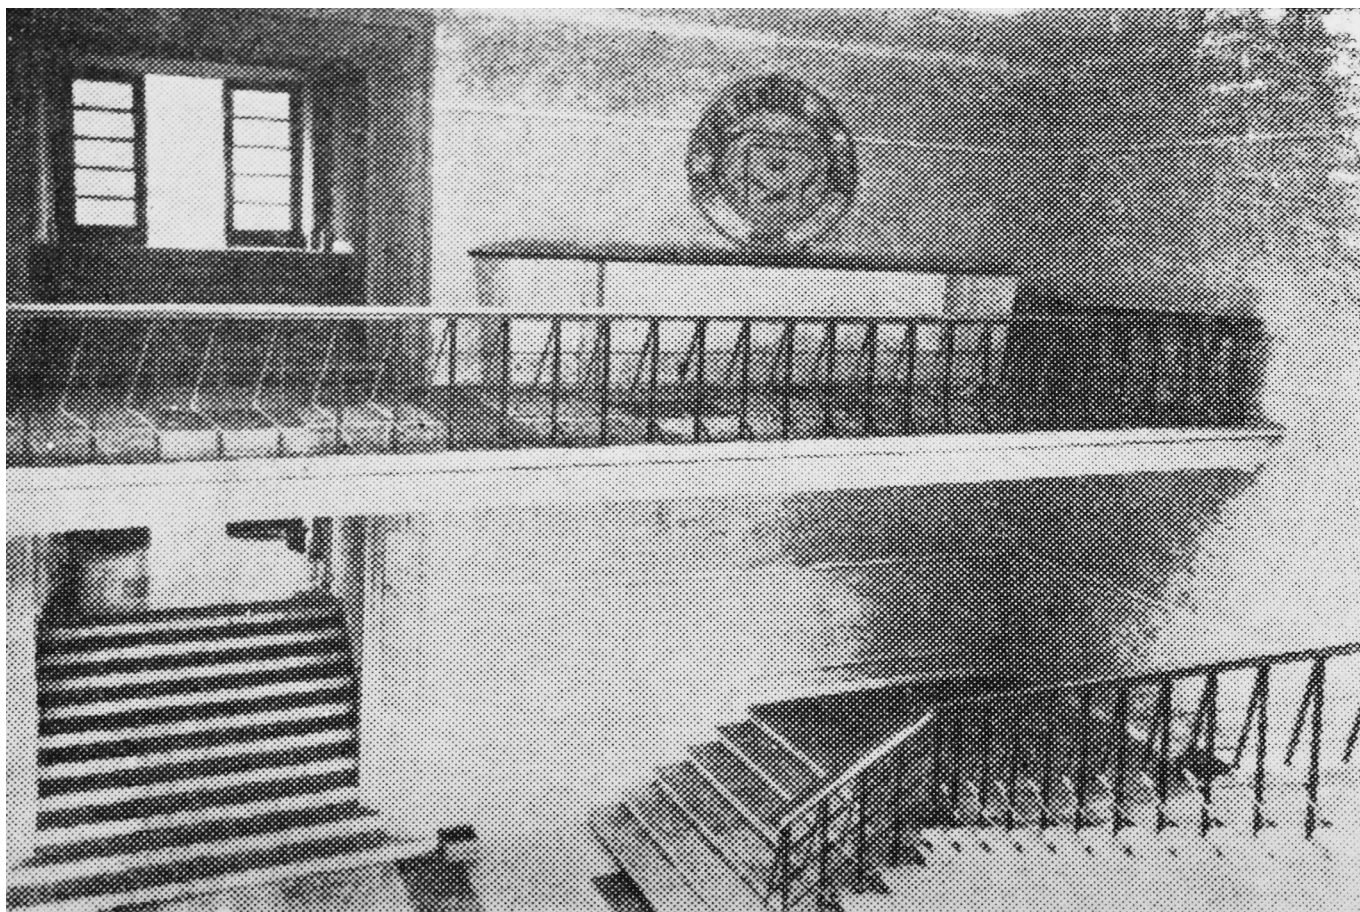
perspectiva de la planta alta del hall principal. A primera vista se observa un pasamano con un diseño característico. Las tonalidades interiores se encuentran en blanco en paredes y entresijos, y composiciones con baldosas en el piso. Además un espacio a manera de mesón que prevalece en el pasillo, coronado por lo que aparenta ser el escudo de la Universidad. El diseño del espacio interior, es plasmado en concordancia a los planos originales, la única modificación en cuanto a los paneles, yace en el diseño del pasamanos.
